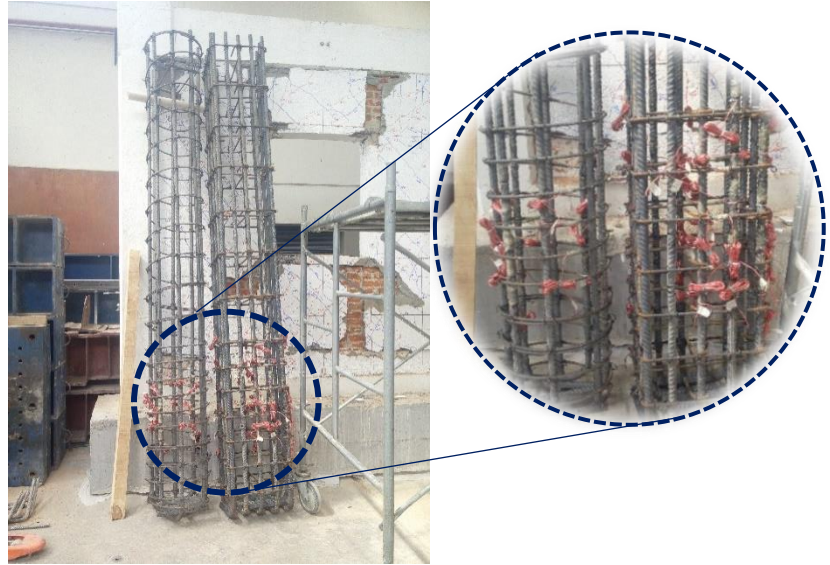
Colocación de los deformímetros eléctricos sobre el refuerzo transversal del espécimen MC-1
